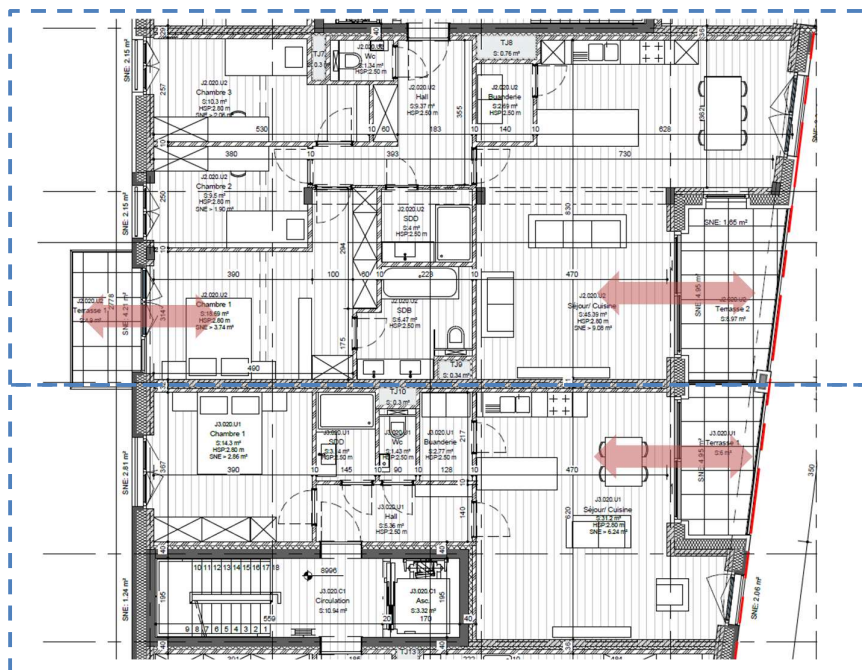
Plans d'un appartement 1 chambre et un appartement 3 chambres type dans Jouret
